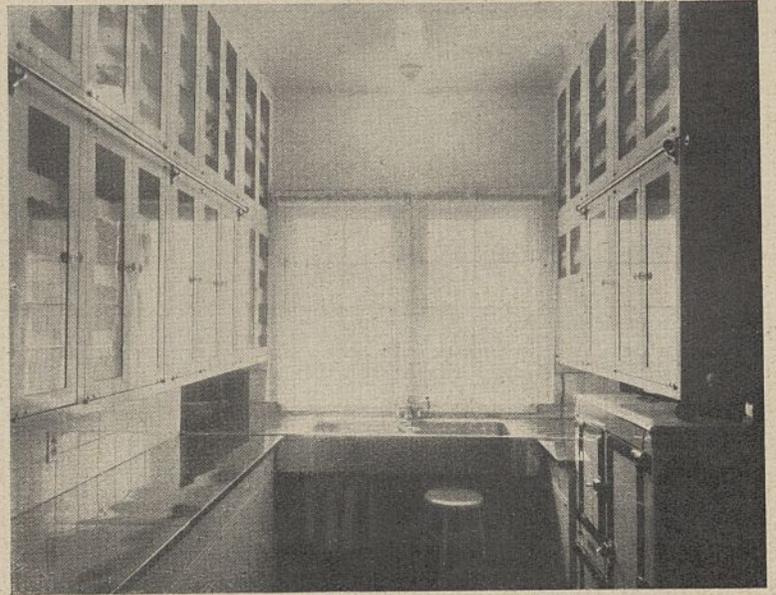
Spülküche mit Geschirrschrank und Kühleinrichtung.
